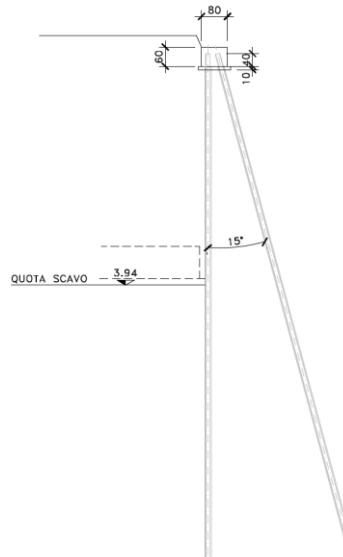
Prospetto e Sezione Paratia tipo D1 E D2
